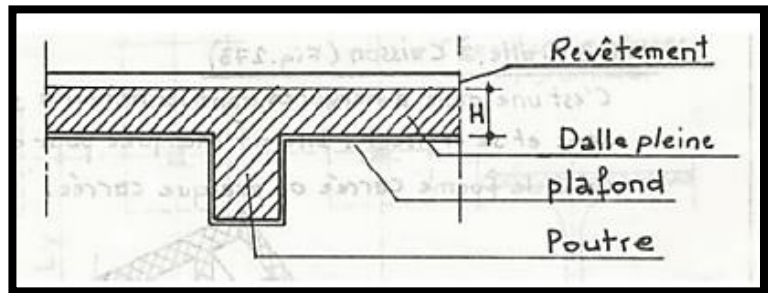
Plancher en béton armé (dalles). Source : Cours : Bâtiment 2 (12/13)
